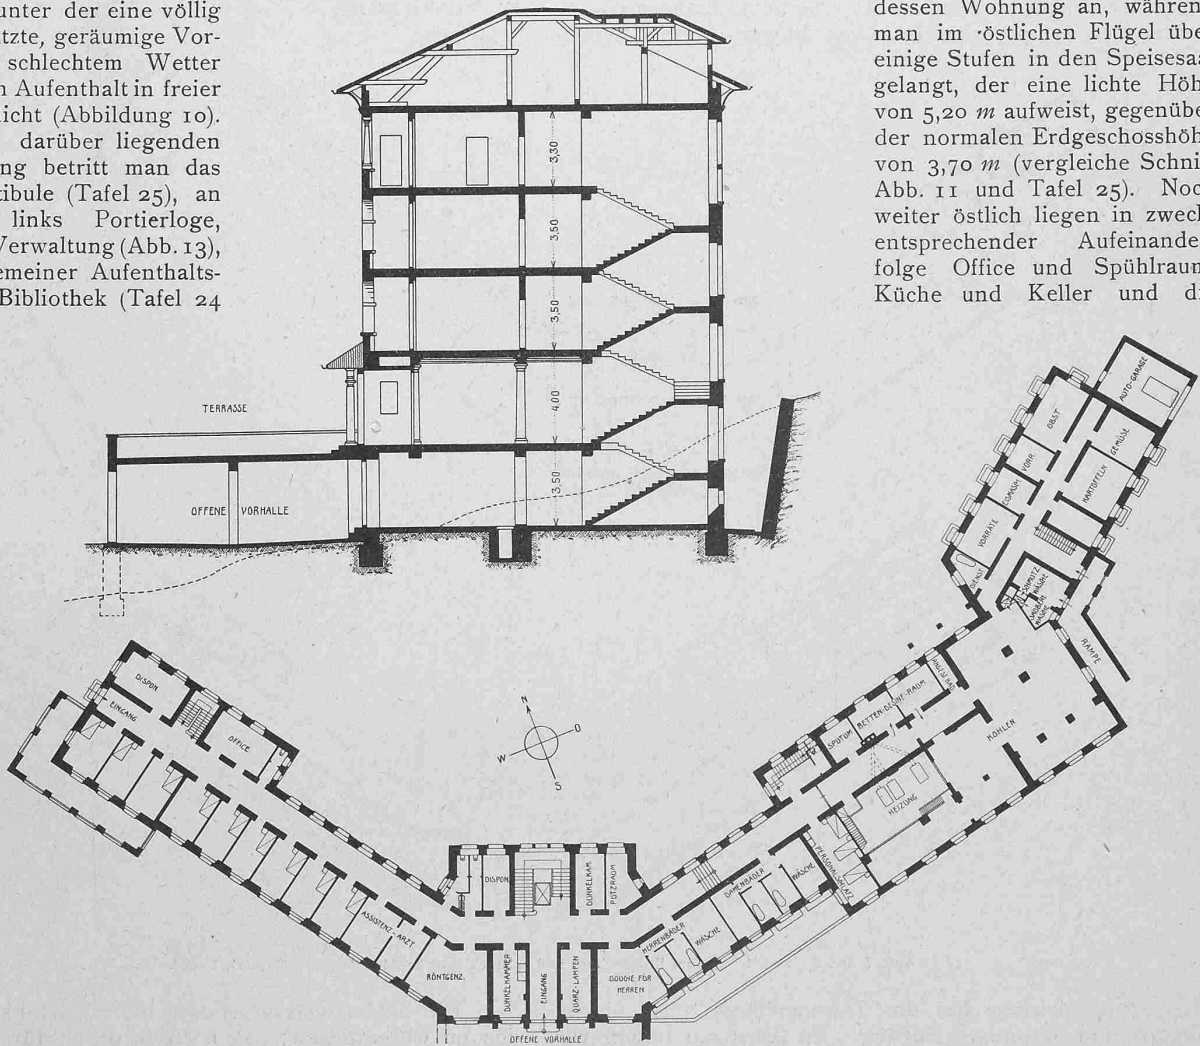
und Abb. 10. Grundriss vom Untergeschoss (für den Westflügel Erdgeschoss) 1 : 600 und Schnitt durch Mittelbau und Anfahrterrasse 1 : 300.
